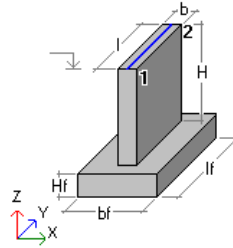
Розрахункова схема фундаменту під колонами
